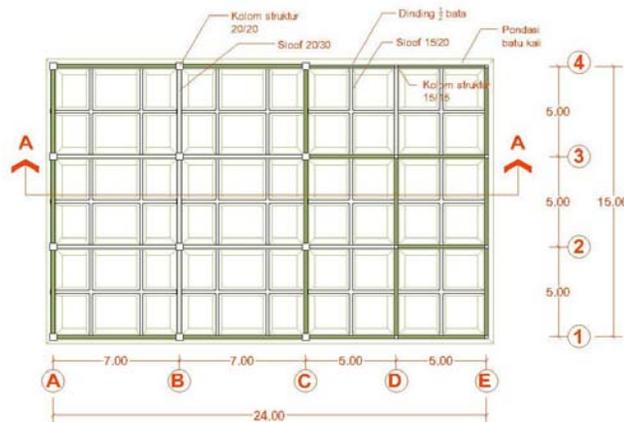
Rencana Pondasi Ruang Musholla
